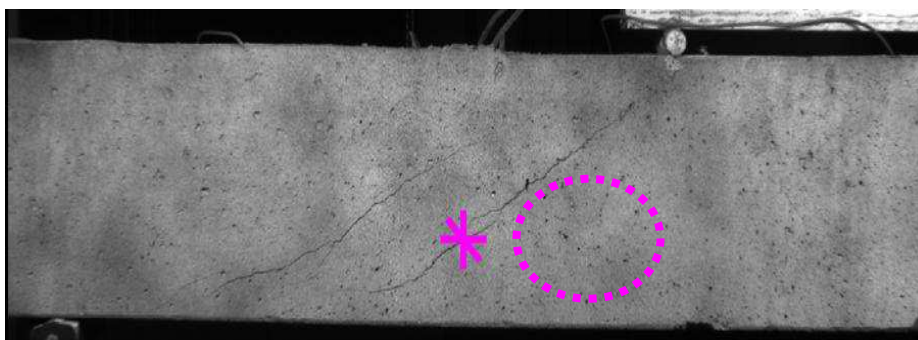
Position de l'extensomètre par corrélation d'images verticale, horizontale et perpendiculaire à la fissure, sur la seconde poutre « R40 »
